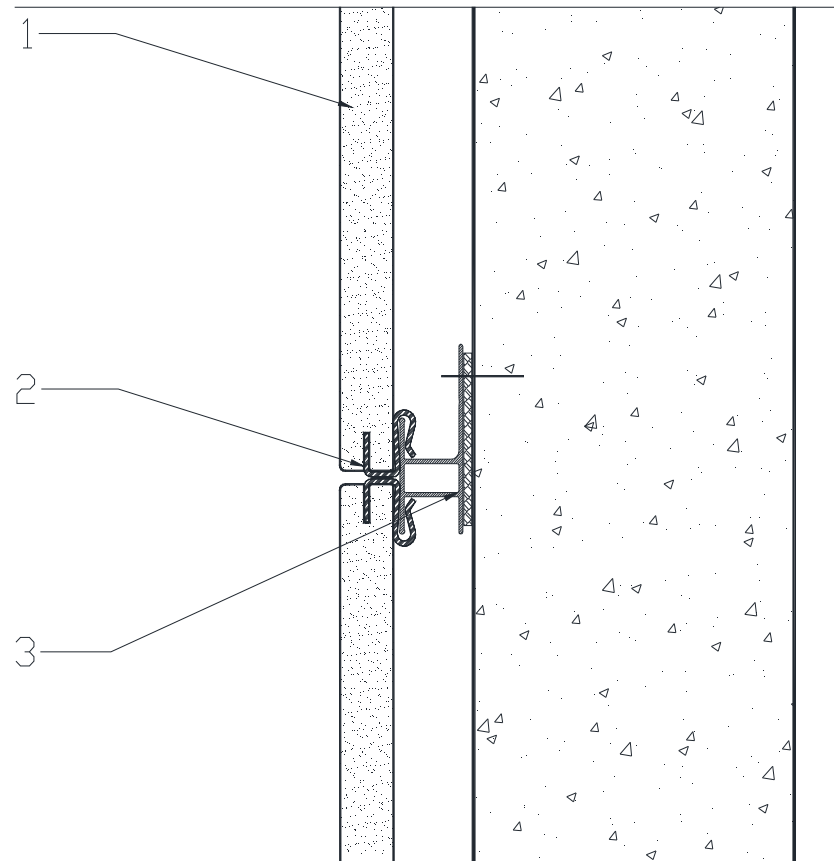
Principe de montage coupe horizontale (joint vertical)
